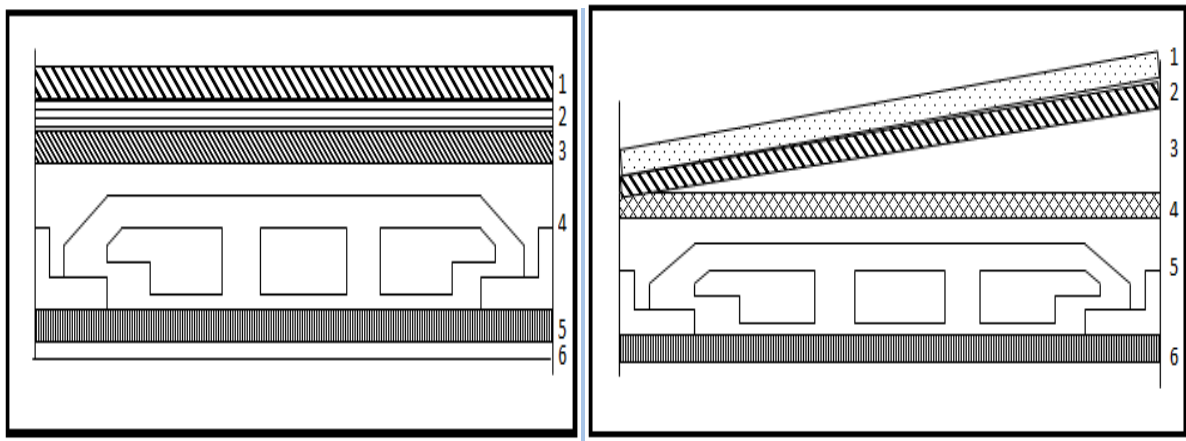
Coupe du plancher courant et Coupe du plancher terrasse à corps creux.
